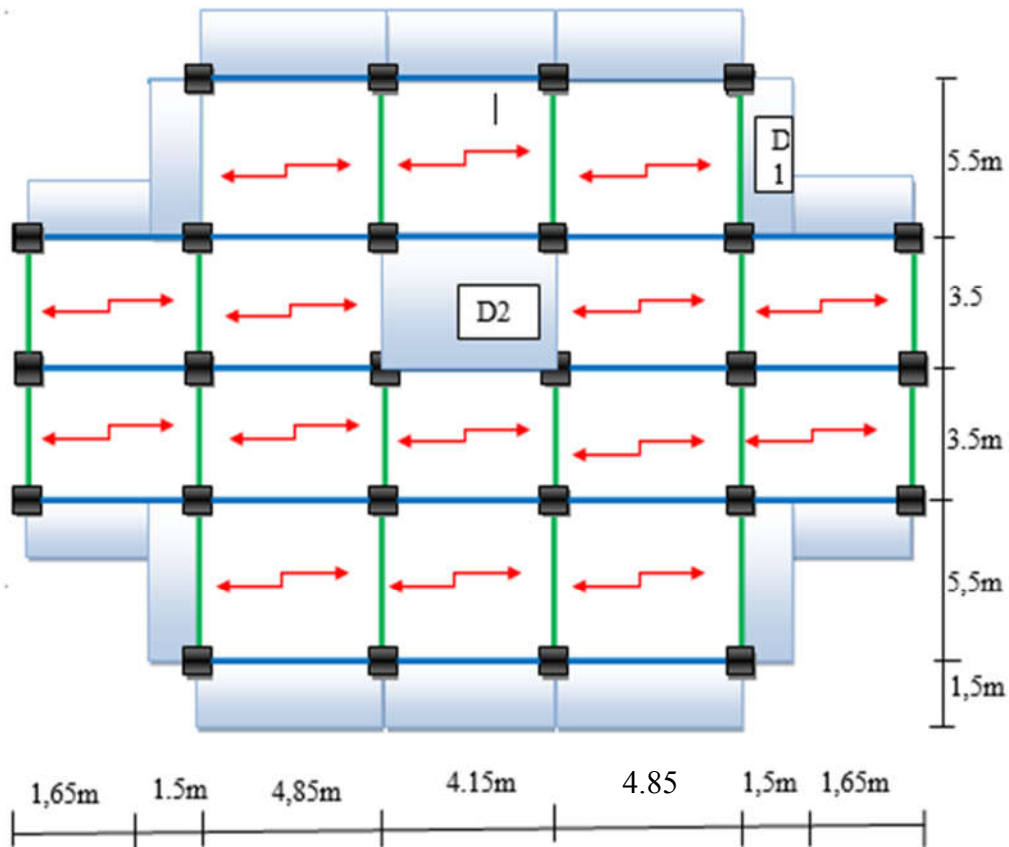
Disposition des poutrelles et les plancher dalle pleine
